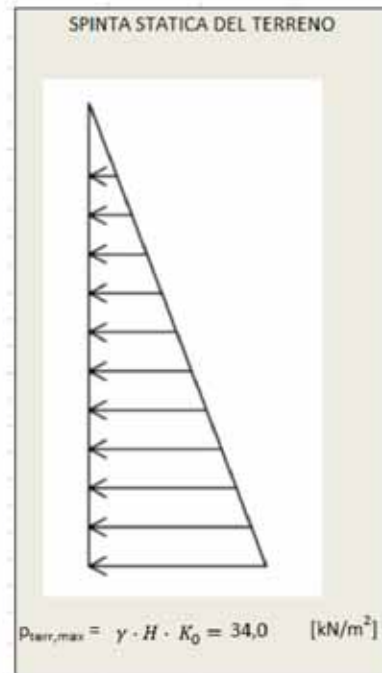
SPALLA B – Spinta statica terreno
